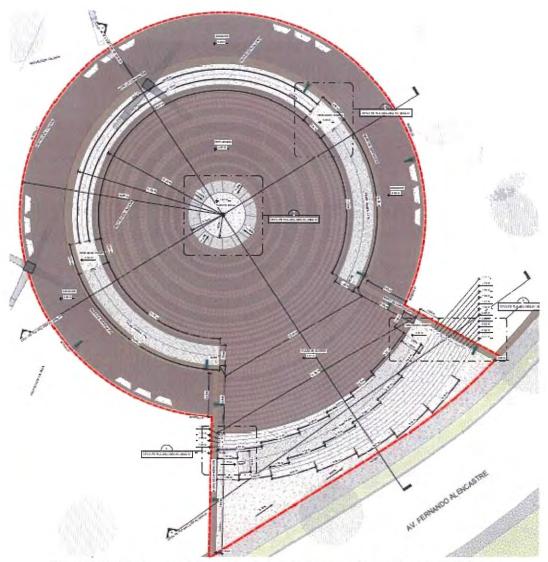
Planta general de la plaza de acceso del desembarque Rosario Castellanos.
